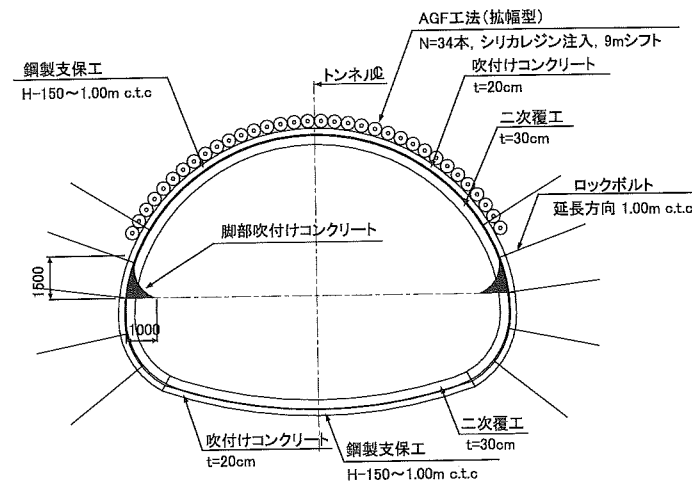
住宅街直下における施工パターン図(施工パターン:A-2-1(脚吹き)工法)
